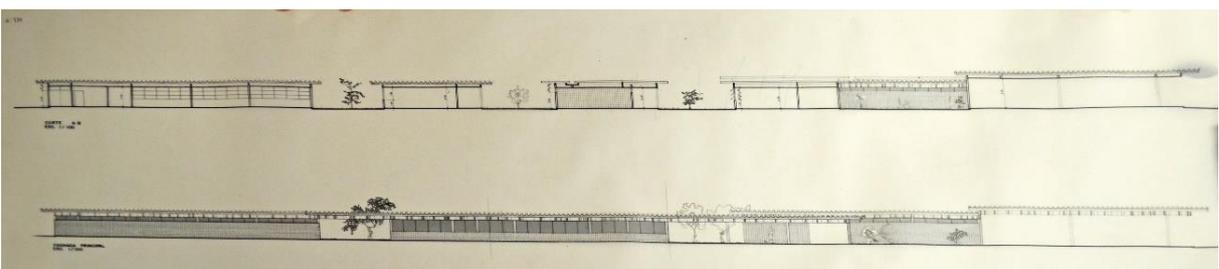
Fachada e Corte do bloco creche, pré-escolar e primeiro grau, proposta de março de 1982.
